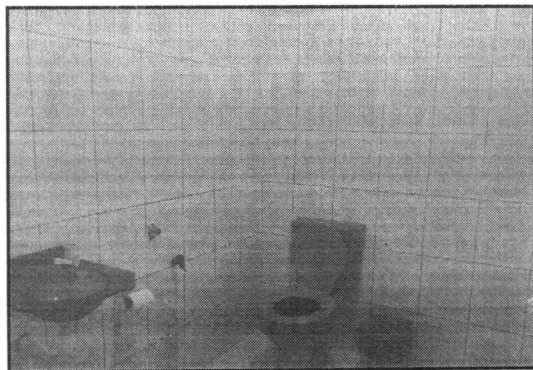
Imagem do Banheiro com pia em louça, sanitário e piso e parede revestidos com cerâmica
